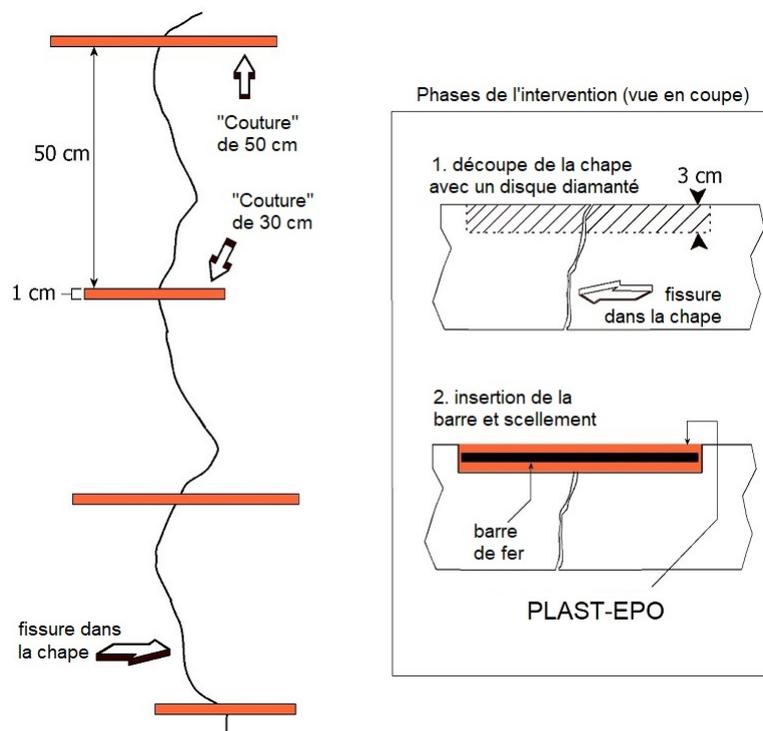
Coudon d'une fissure en MOUVEMENT
